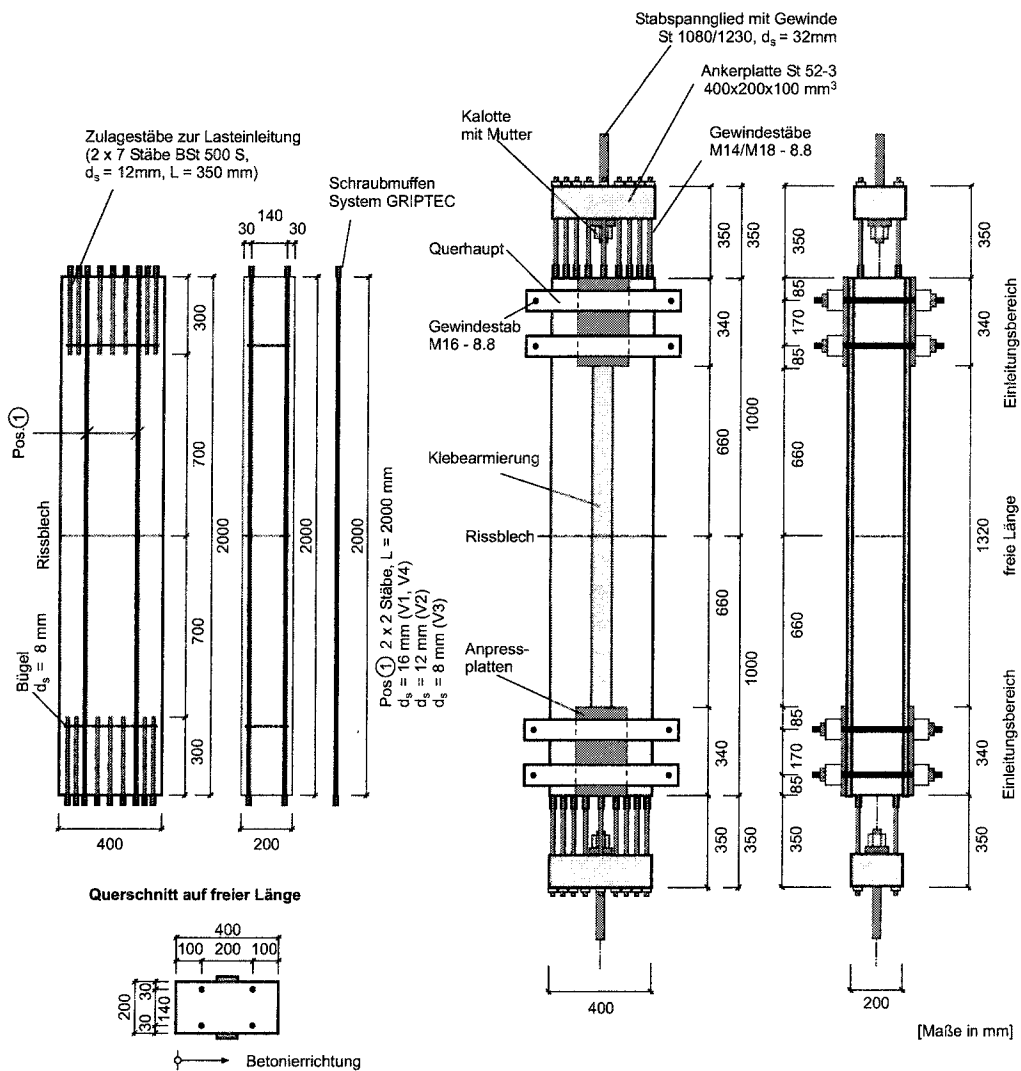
Dehnkörper der Versuchsreihen V1, V2, V3 und V4 - Bewehrung und Versuchsaufbau (Schraubmuffenanschluss der durchlaufenden Bewehrung exemplarisch, vgl. Abb. 3.15; zusätzliche Rissbleche der Reihe V4 nicht dargestellt)
